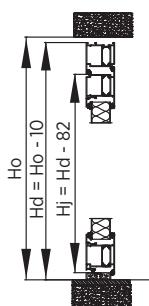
Montaggio in foro - sezione verticale - porta a un'anta - sistema MB60E.
